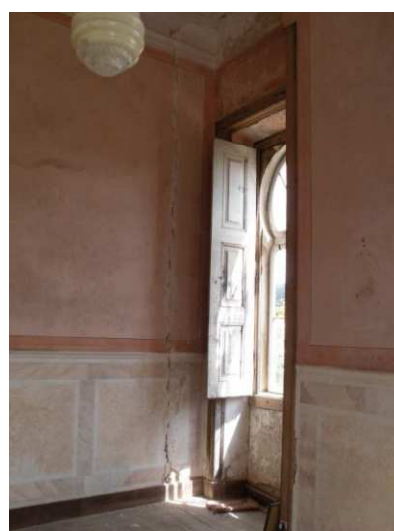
Fissuração e fendilhação nas paredes divisórias do 1º piso.
